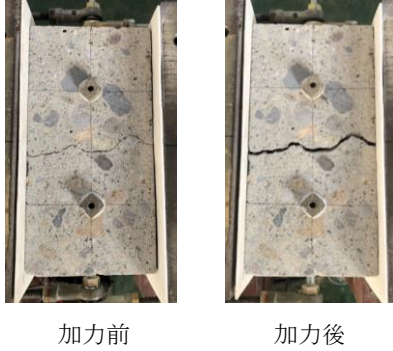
加力前後のひび割れ状態 (M-1.00-3)
